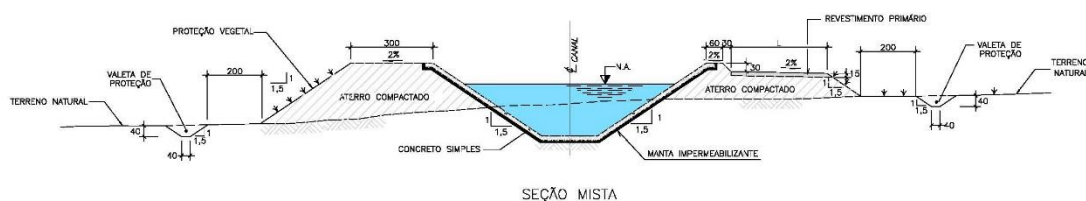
Seção Típica dos Canais Trapezoidais Dimensionados
